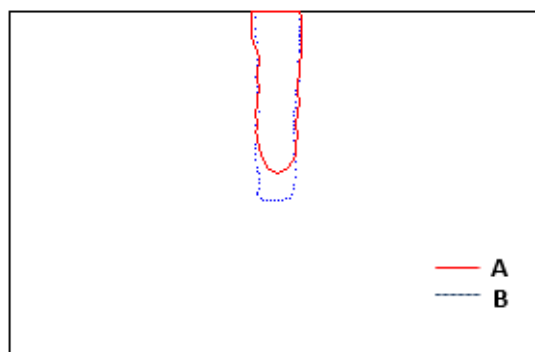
Caixa 3: Comparação entre colunas executadas com pilão tipo A e pilão tipo B
